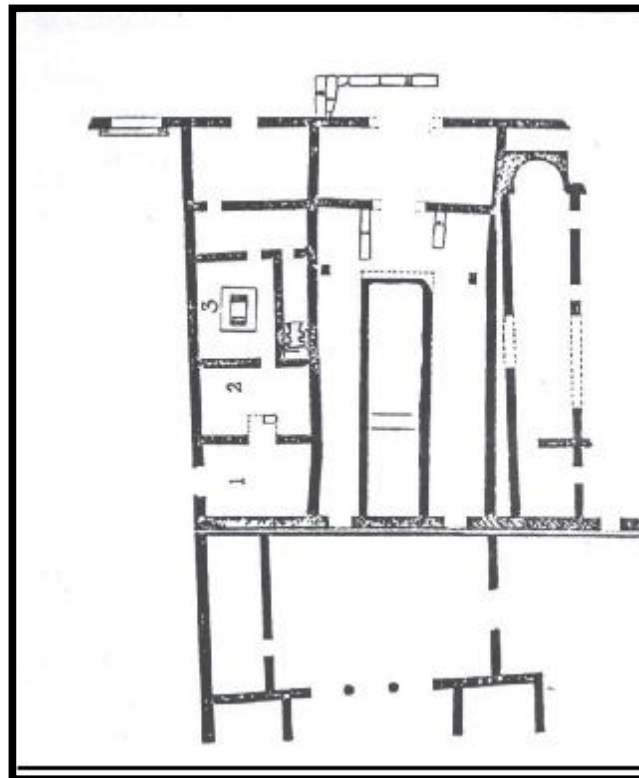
مسقط أفقي لمبنى الكنيسة الغربية
